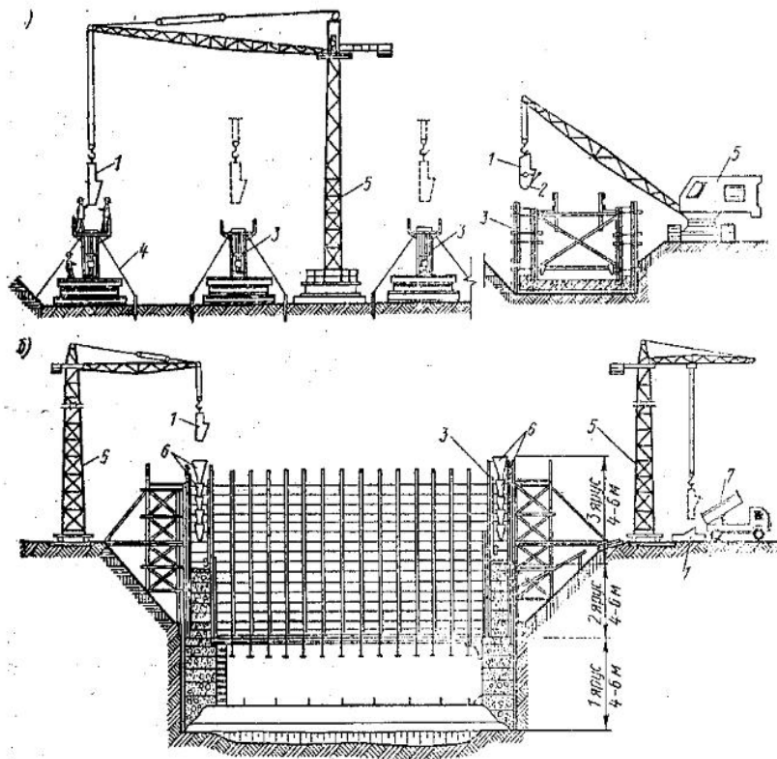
подача бетонної суміші за допомогою кранів:
